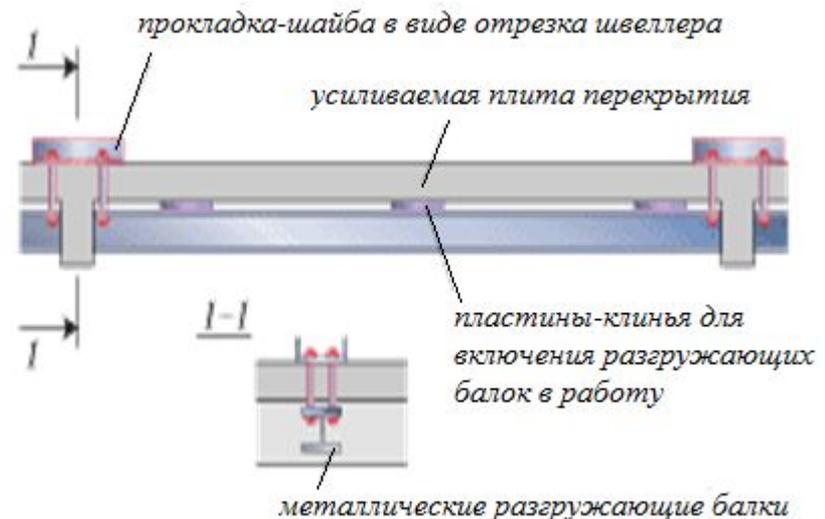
Усиление разгружающими балками снизу перекрытия
